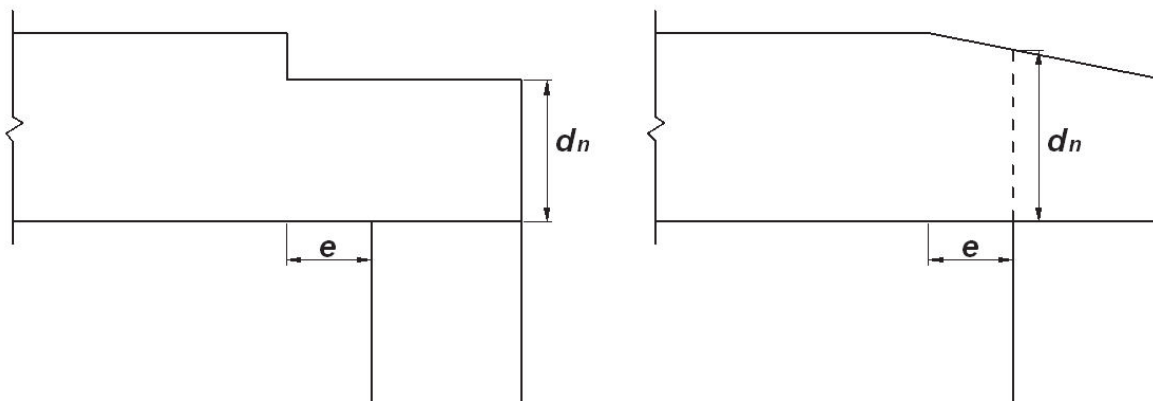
Vigas entalladas en la cara comprimida.
